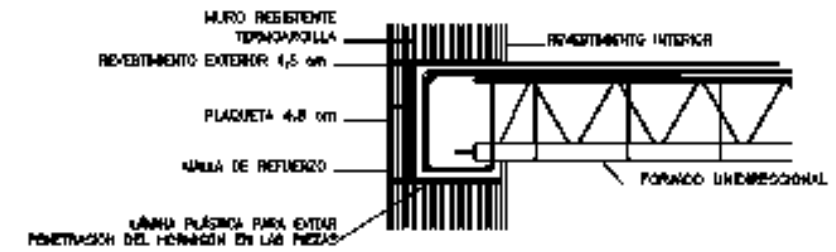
Apoyo del forjado en muro portante. Solución con pieza L girada.
